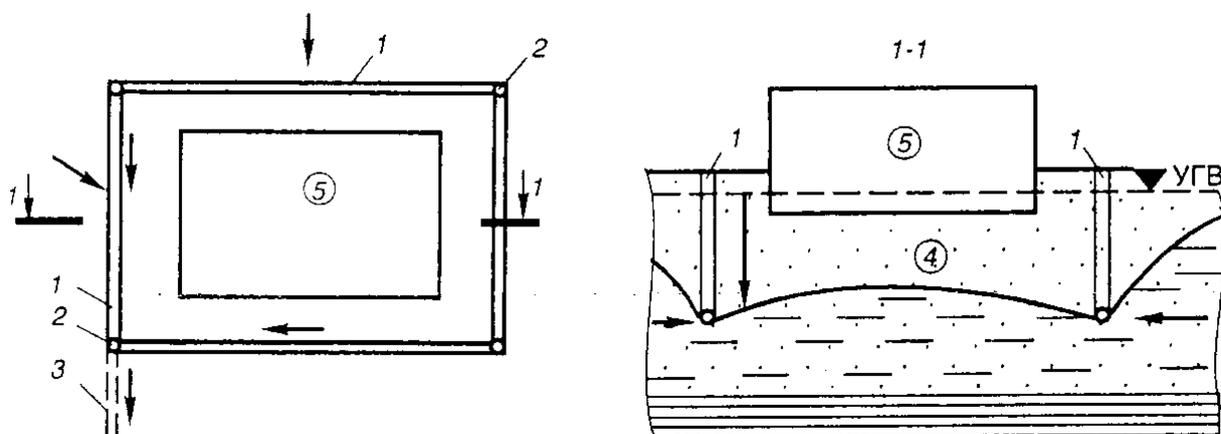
Кольцевой дренаж (план и разрез участка): 1 – дрены; 2 – смотровые колодцы; 3 – сбросная часть дренажа; 4 – пониженный уровень воды; 5 – здания
